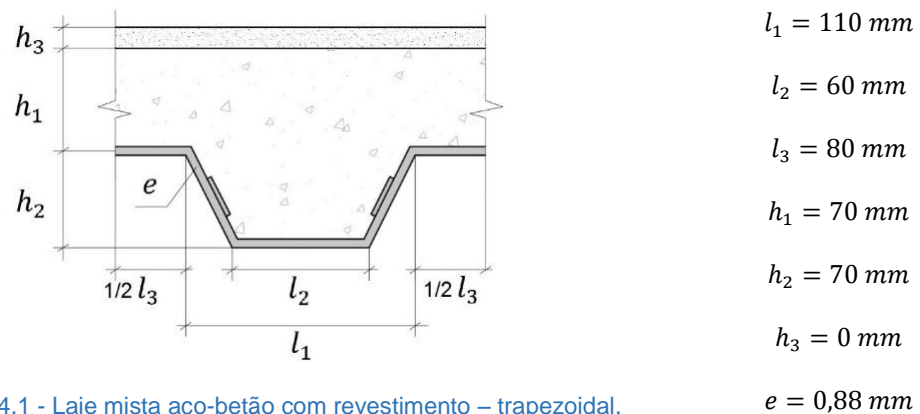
Laje mista aço-betão com revestimento – trapezoidal.
